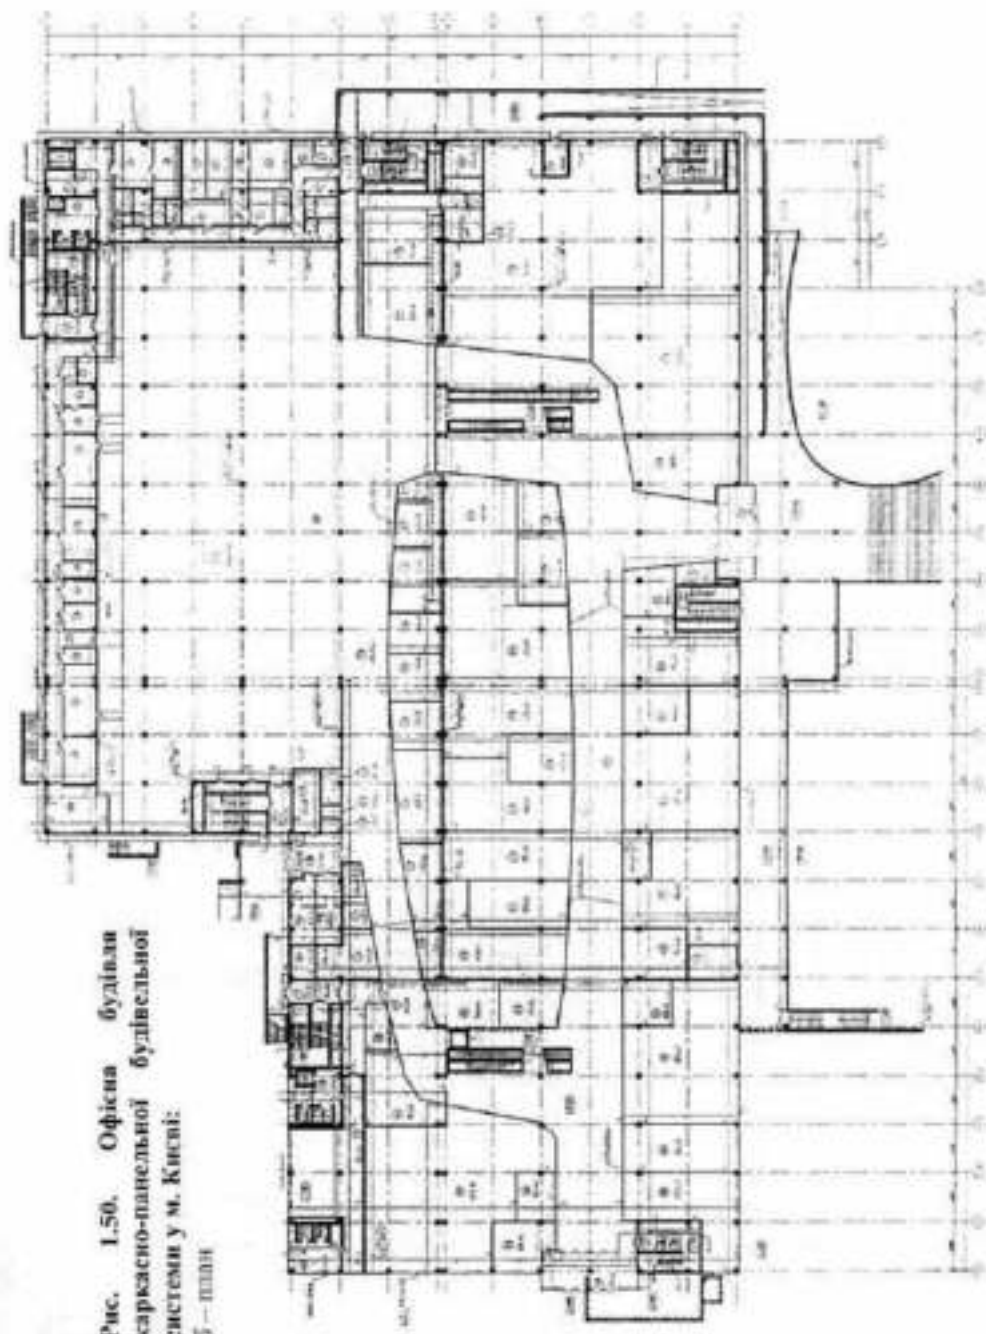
Офісна будівля каркасно-панельної будівельної системи у м. Києві:
